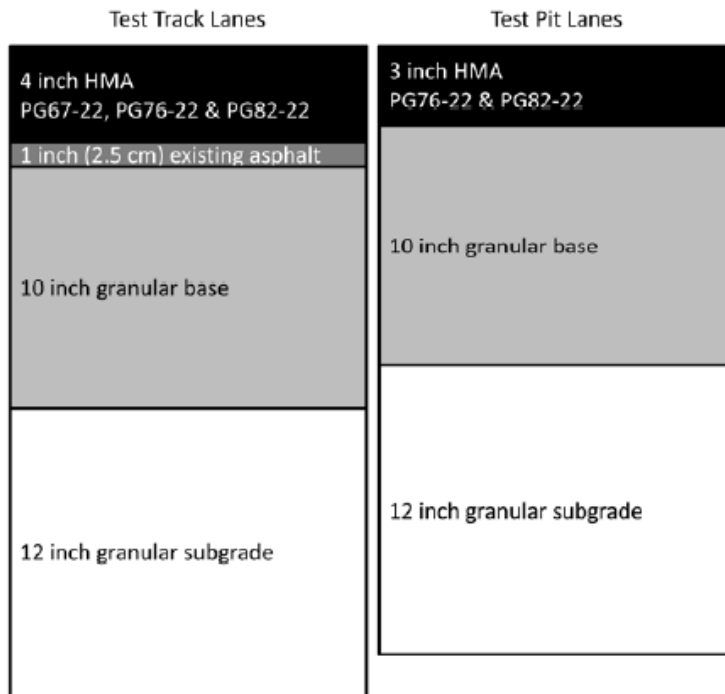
Estructura del pavimento. Fuente: Evaluation of a Heavy Polymer Modified Binder through Accelerated Pavement Testing (Greene, Choubane, & Chun, 2013).
